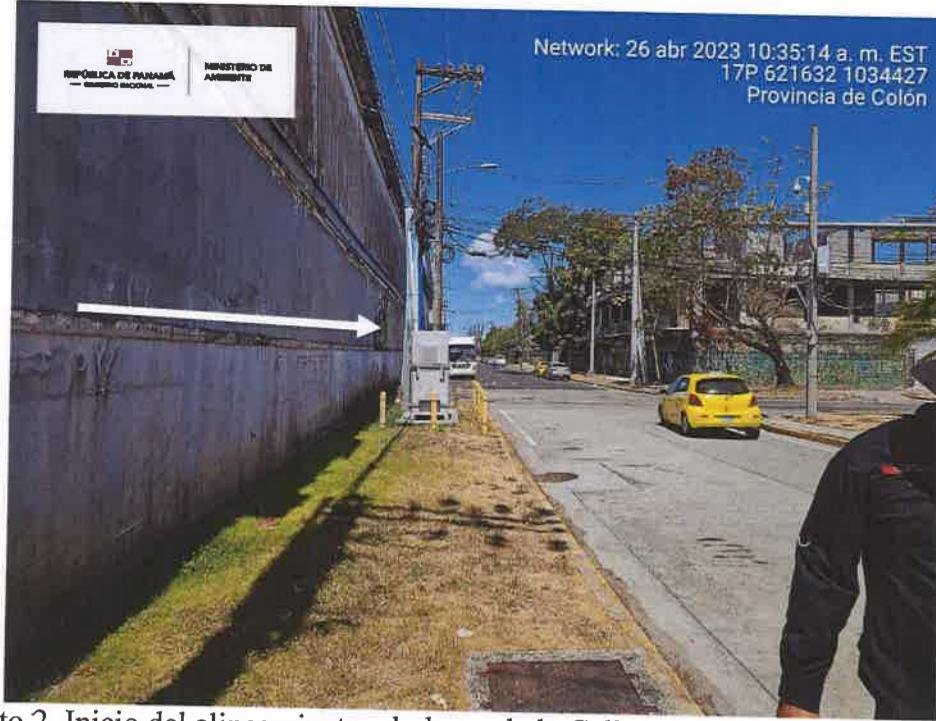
Inicio del alineamiento a lo largo de la Calle 13, donde se harán trabajos de pintura sobre el muro existente.
